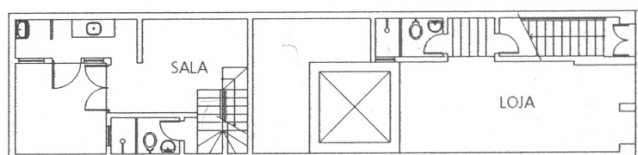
Rua do Livramento, 145 – Planta baixa do térreo (SECRETARIA, 2000, p. 52).
